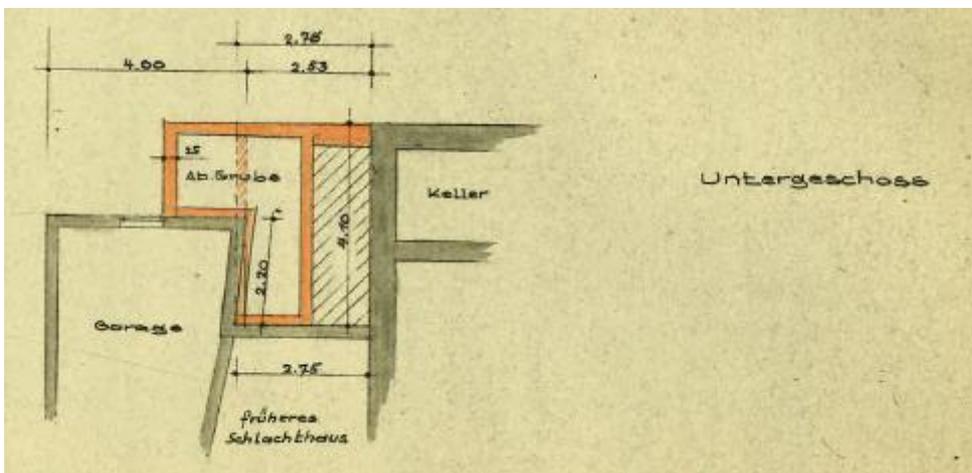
Bestandsplan Grundriss Untergeschoss, zugesendet am 02.03.2023 durch die Stadt Aichtal
